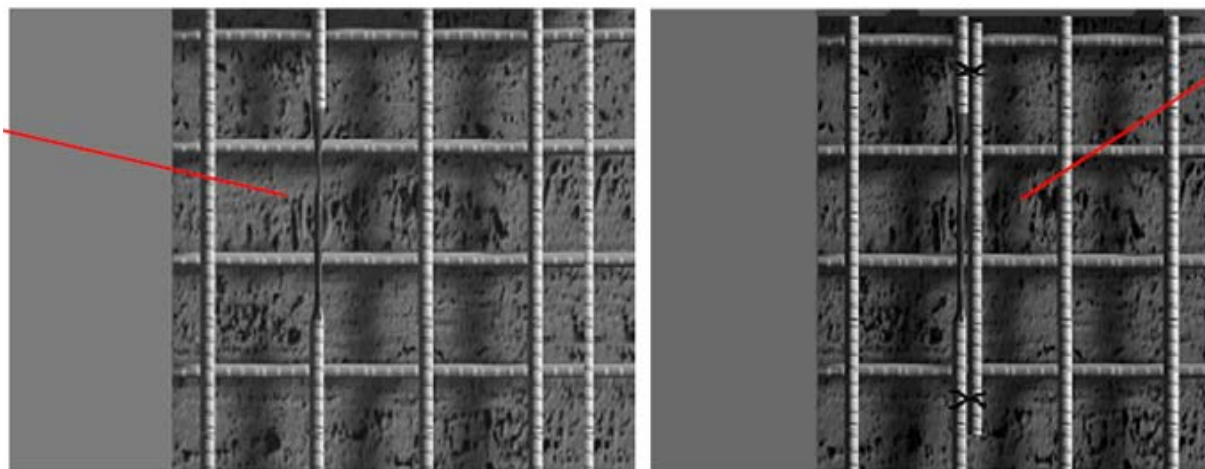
ferdig utmeislet kloridinfisert betong, men sveket konstruksjon [5]
